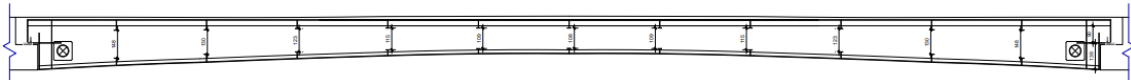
Corte longitudinal do tabuleiro metálico. [6]
